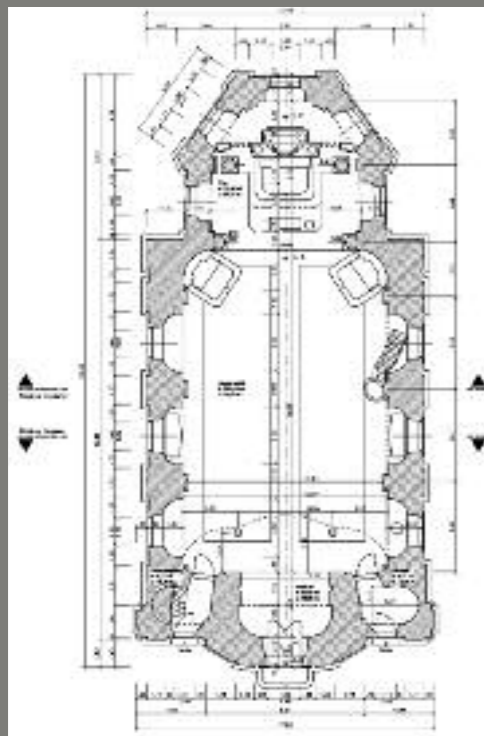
Zella, Propsteikirche, Grundriss
